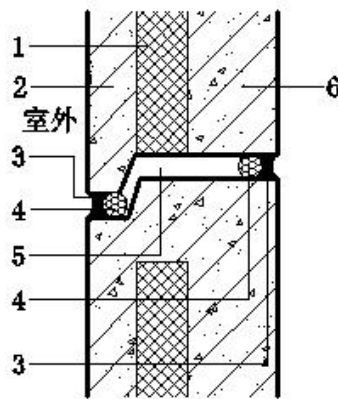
预制混凝土夹心保温外挂墙板水平接缝防水构造
